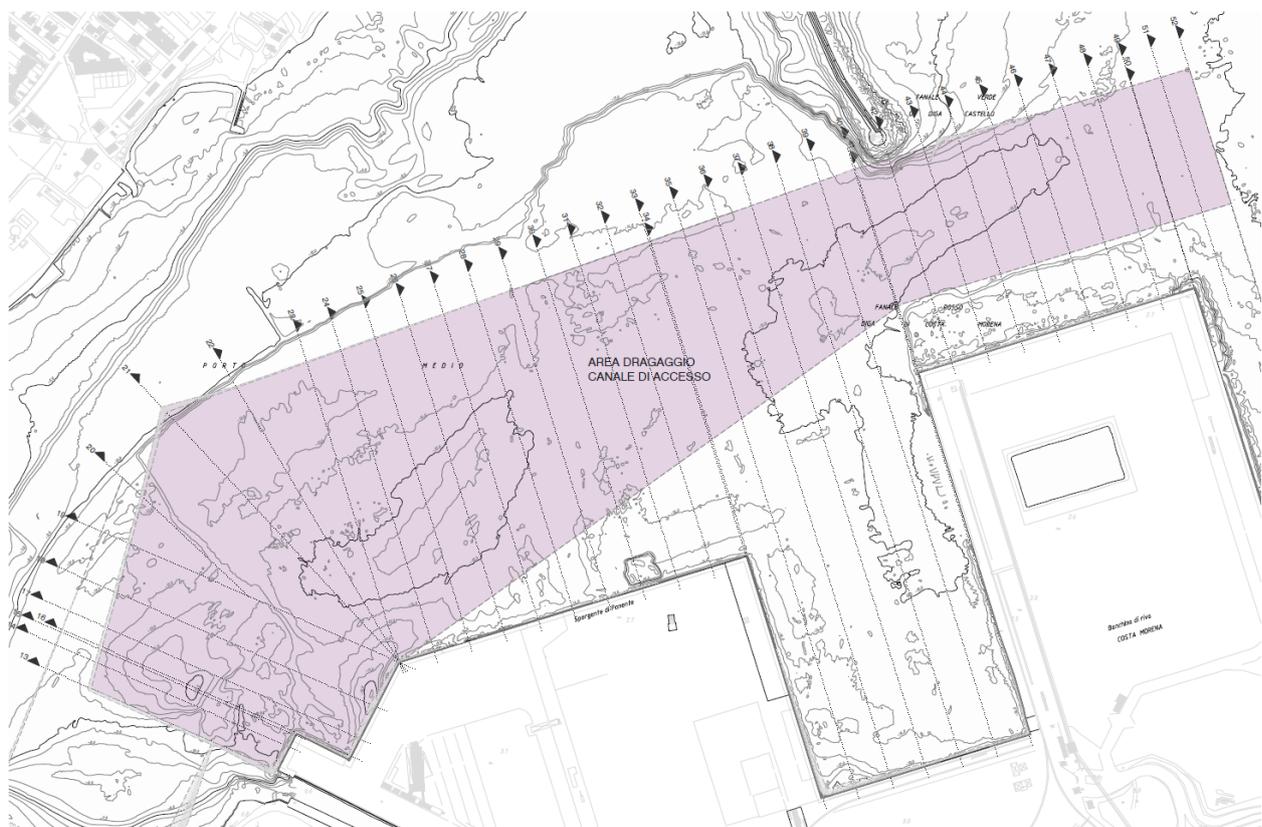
Stralcio della planimetria generale di dragaggio (Cfr. 09-017-DT-202-1-PLA)
